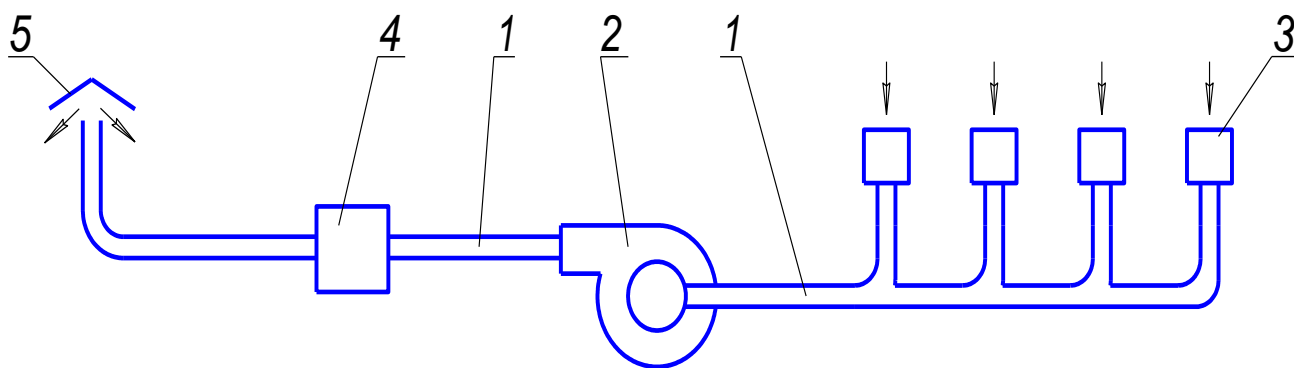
Схема общего вида: 1 – воздуховод; 2 – устройство для очистки воздуха - циклон; 3 – вытяжные отверстия или насадки; 4 – побудитель движения; 5 – устройство для выброса воздуха.
